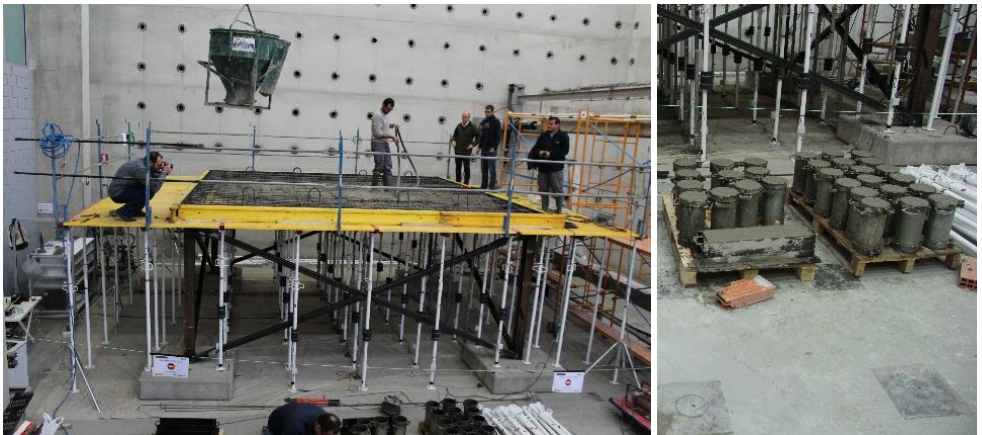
Hormigonado de la losa y fabricación de probetas.
